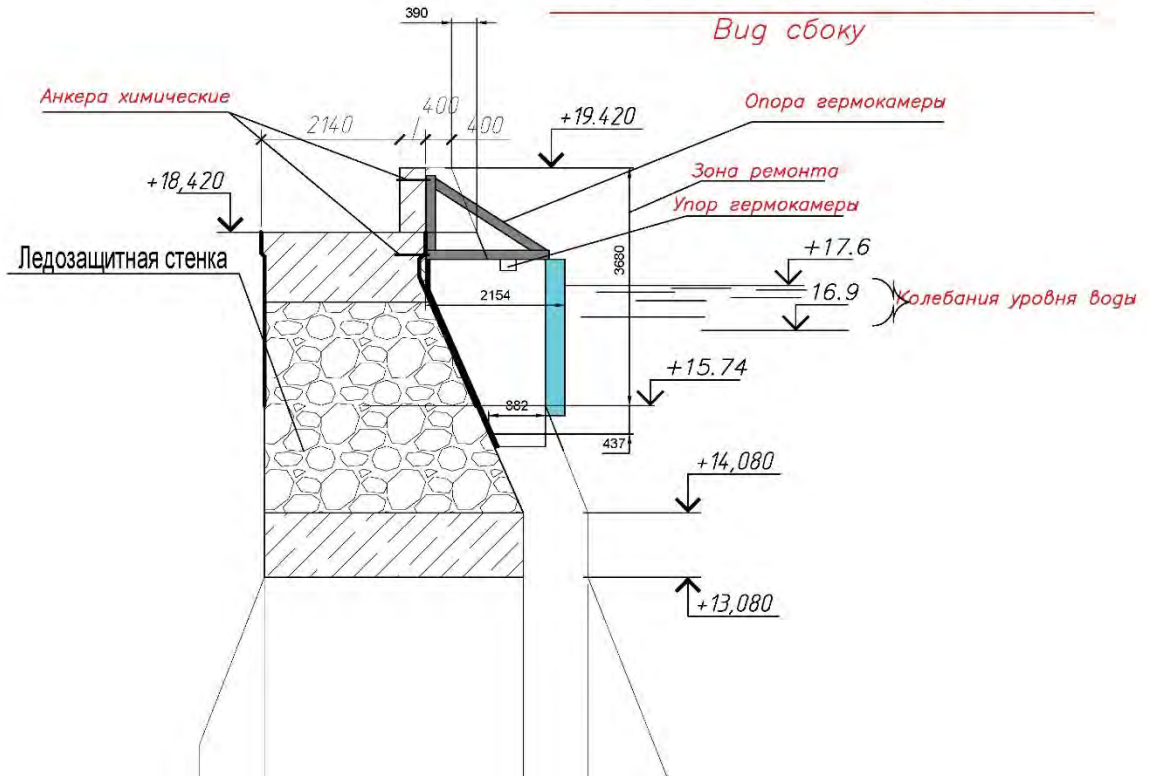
Схема установки гермокамеры ГС16 (вид сбоку)
